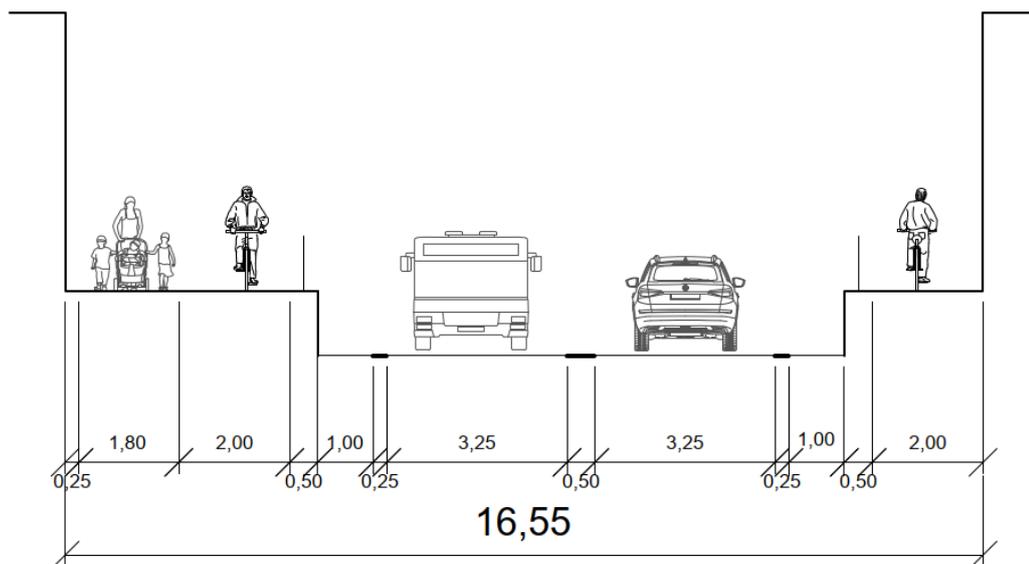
Querschnitt einer Eisenbahnüberführung (Tunnel) mit abgesetzten Rad- und Fußwegen
